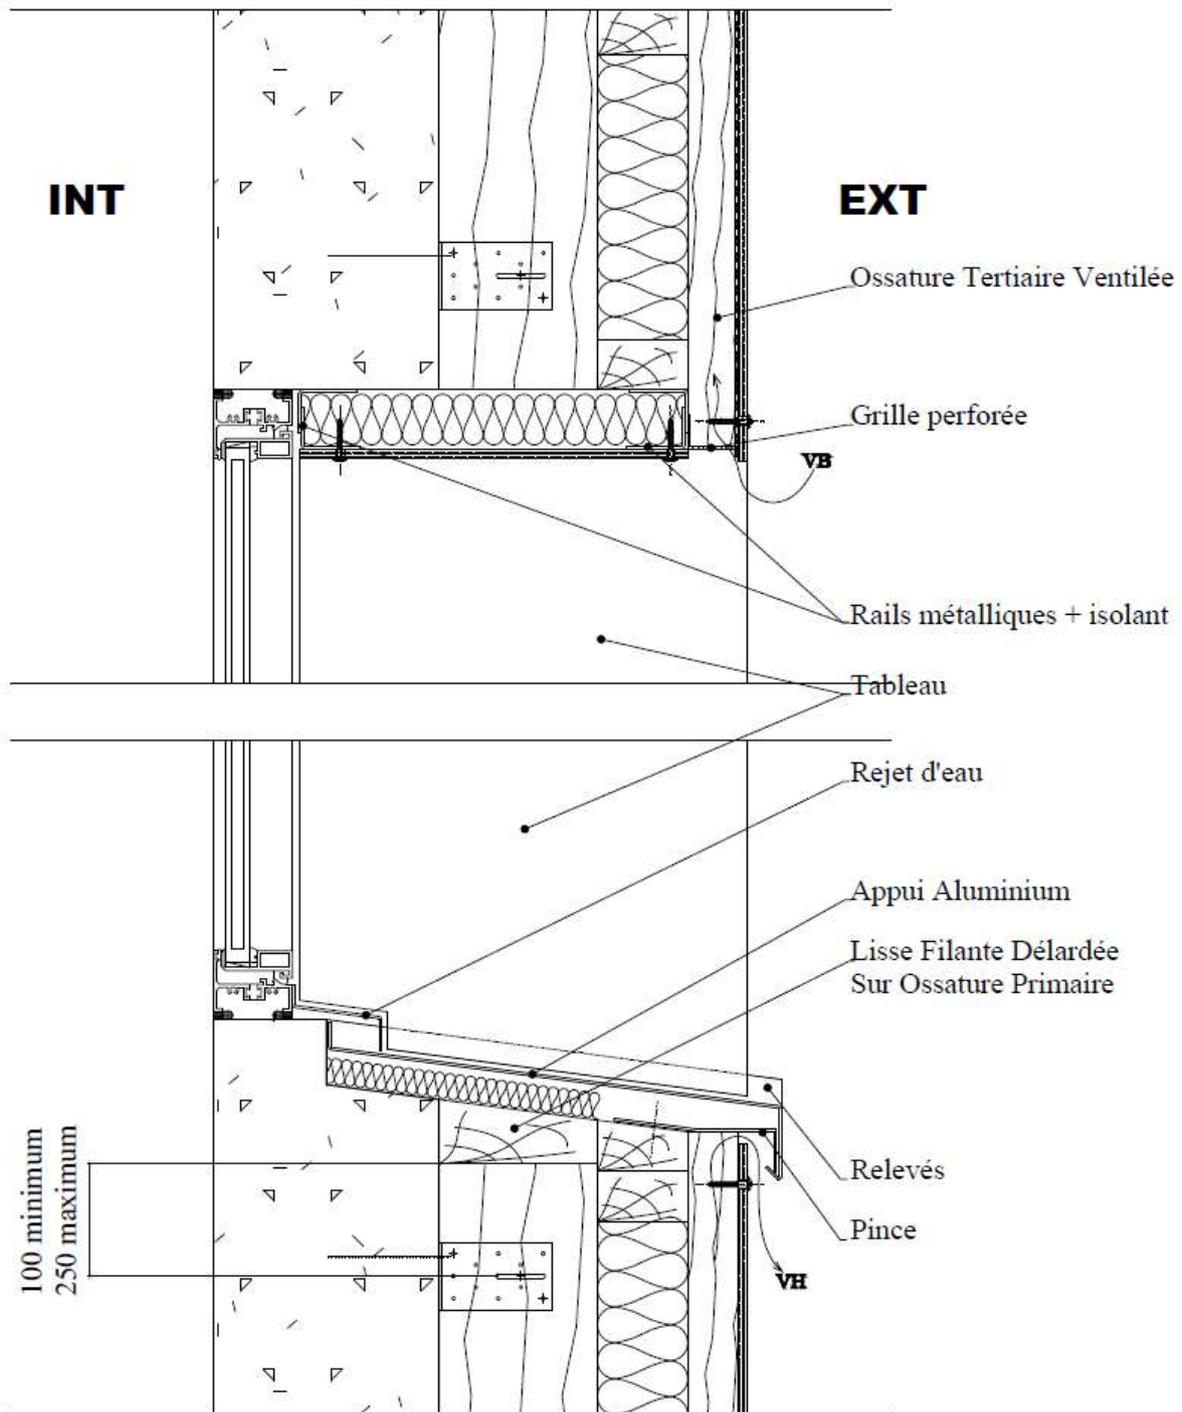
Traitement sur BA en multi réseau - Coupe verticale sur voussure et appui de menuiserie
